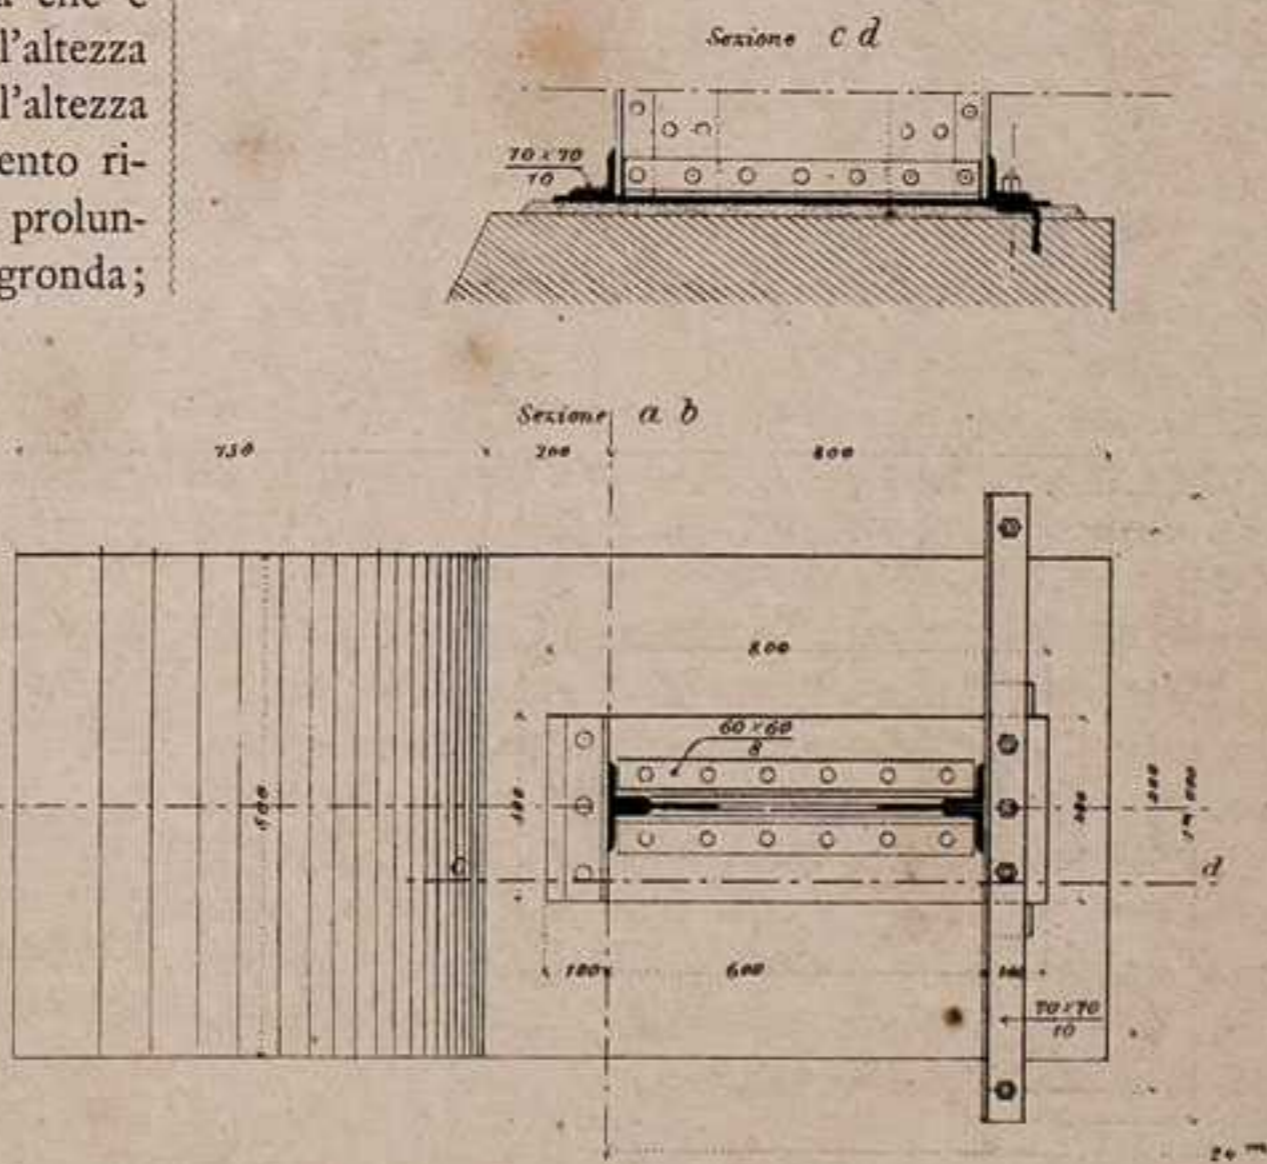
Particolari dell'unione del piedritto alla muratura di fondazione. Scala di 1 a 20.
